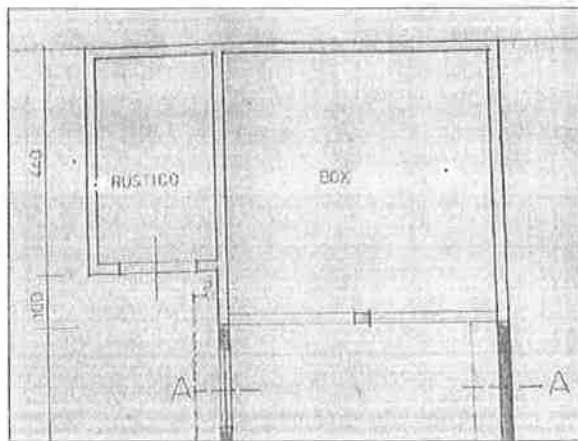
Planimetria del sub.2 allegata alla C.E N. 356 del 19.01.1982
